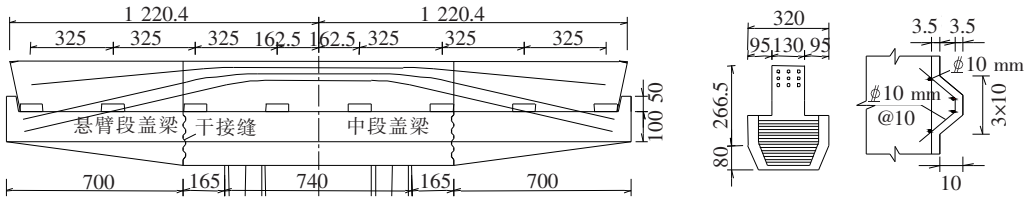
预制拼装盖梁构造尺寸及剪力键构造配筋图(单位:cm)
